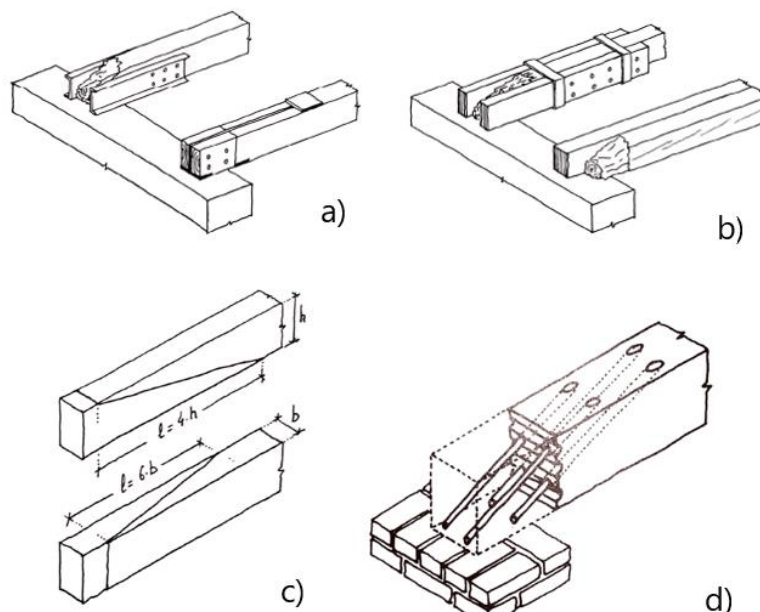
Tipos de empalme em zonas de apoio com: a) chapas metálicas; b) madeira; c) substituição parcial por madeira sã; d) epoxi e barras de reforço (Arriaga; et al, 2002)
